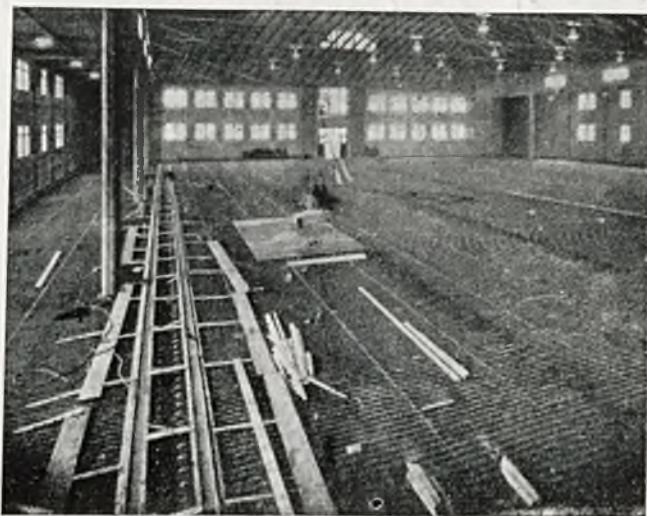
Budowa instalacji oziębiającej dla sztucznego toru łyżwiarskiego, z rur spawanych.
